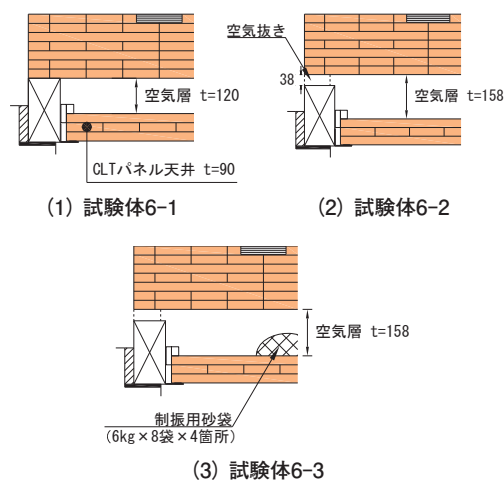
試験体6-1～6-3の断面図 (寸法単位:mm)
